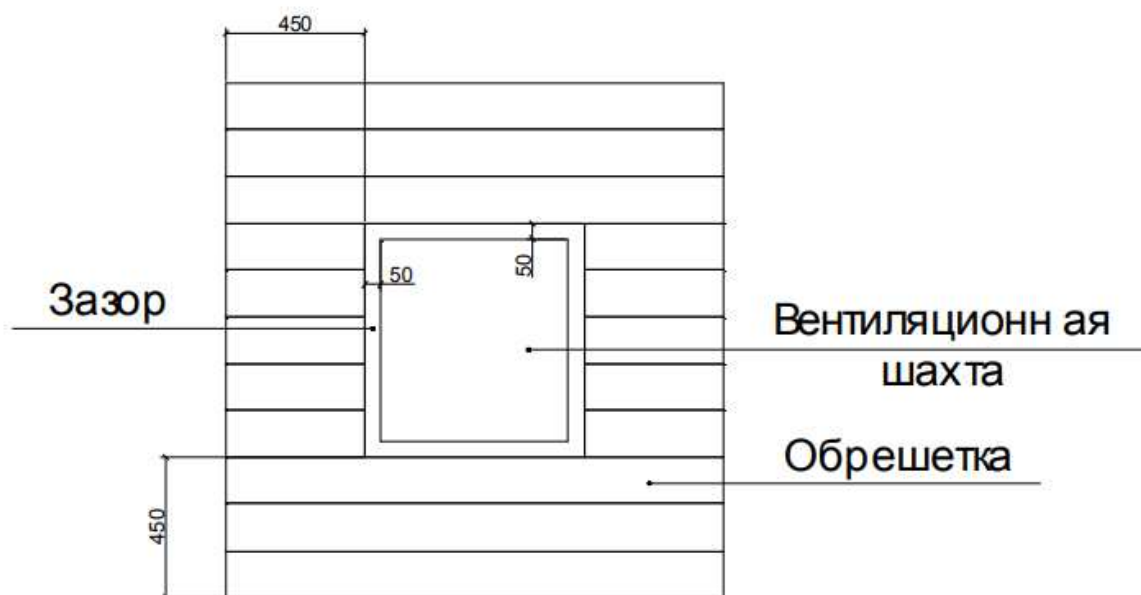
Схема расположения сплошной обрешетки вокруг вентиляционной шахты
